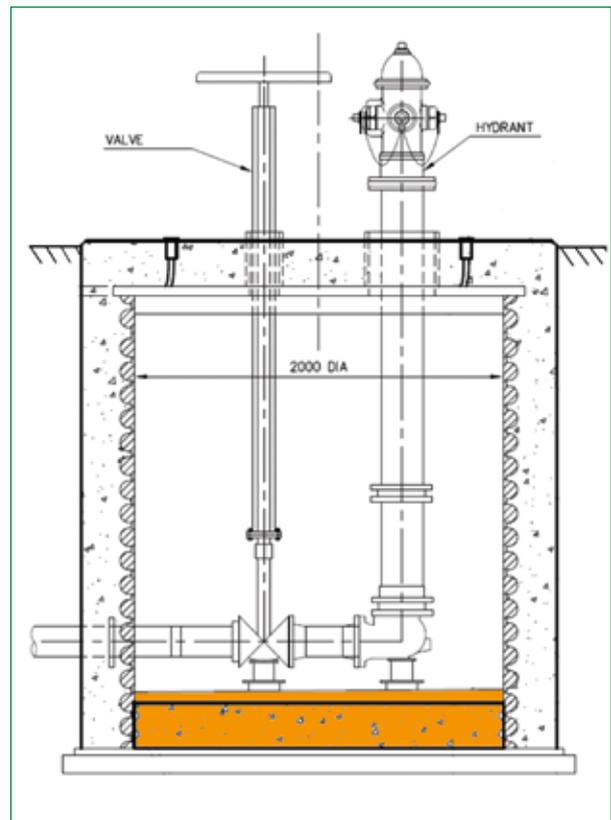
Schachtzeichnung mit Betonboden und Armaturen
